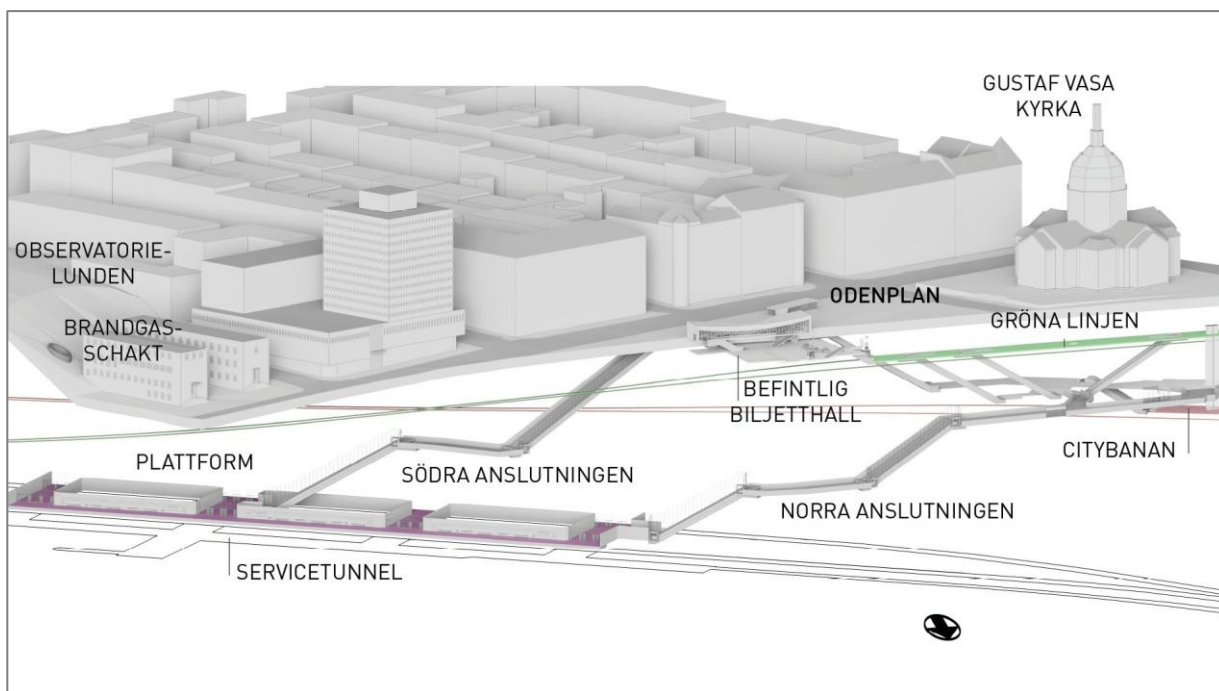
Situationsplan över Odenplan, som visar de underjordiska stationerna med Roslagsbanan i lila, pendeltåg (Citybanan) i rosa och tunnelbana (Gröna linjen) i grönt.
